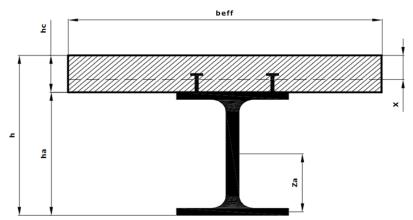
Calcul de l'inertie d'une poutre mixte.
